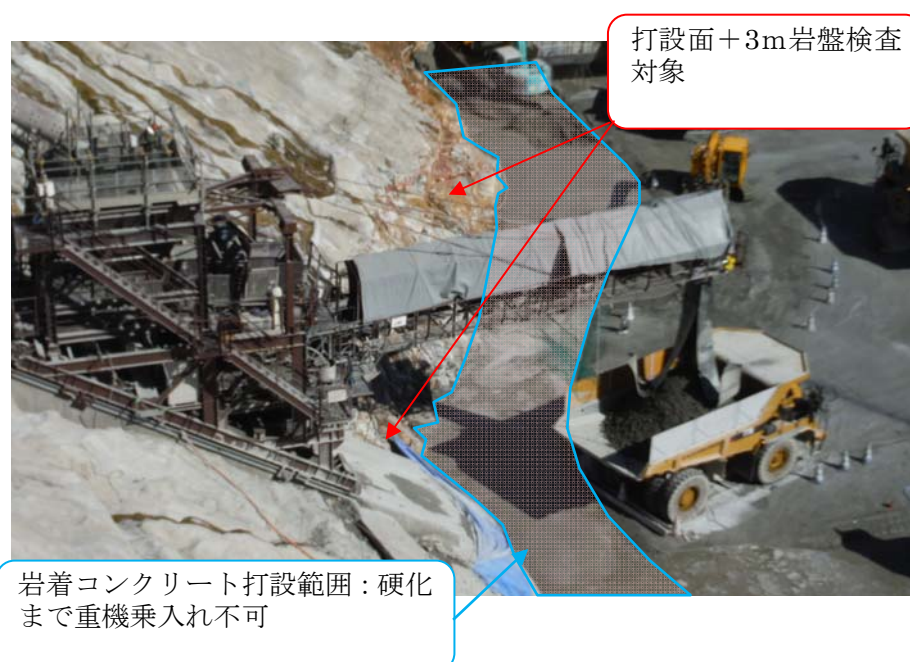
硬化前の岩着コンクリートを避けて 40t ダンプトラックへ供給
